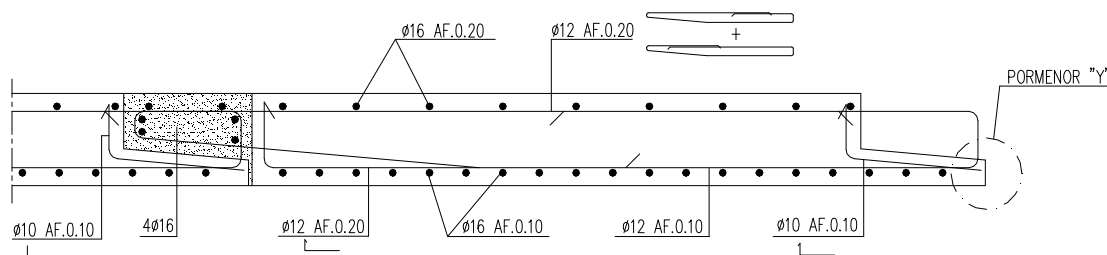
Pormenor de ligação de duas lajes consecutivas
